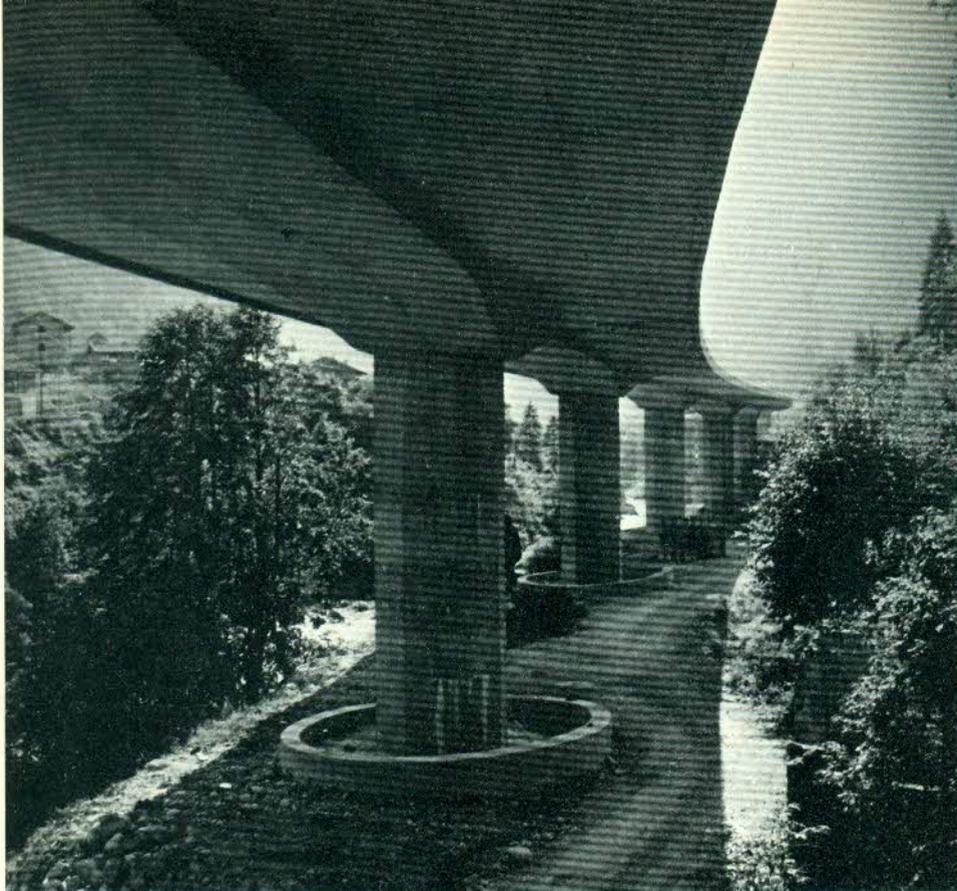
Dettagli strutturali delle pile e dell'impalcato del viadotto di Pietratagliata
